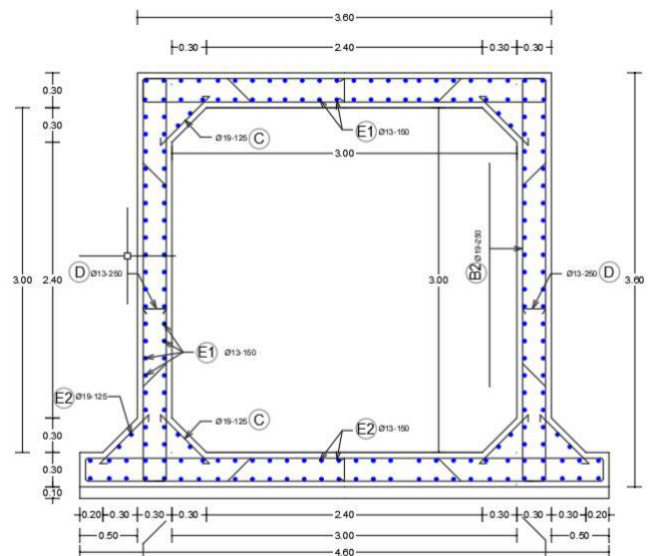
Box Culvert Saluran Raman Utara Existing
